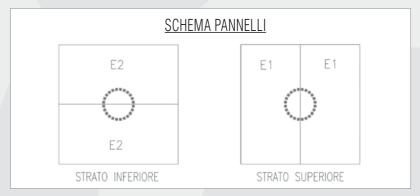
Disposizione dei moduli FAST SITE® SYSTEM 18
